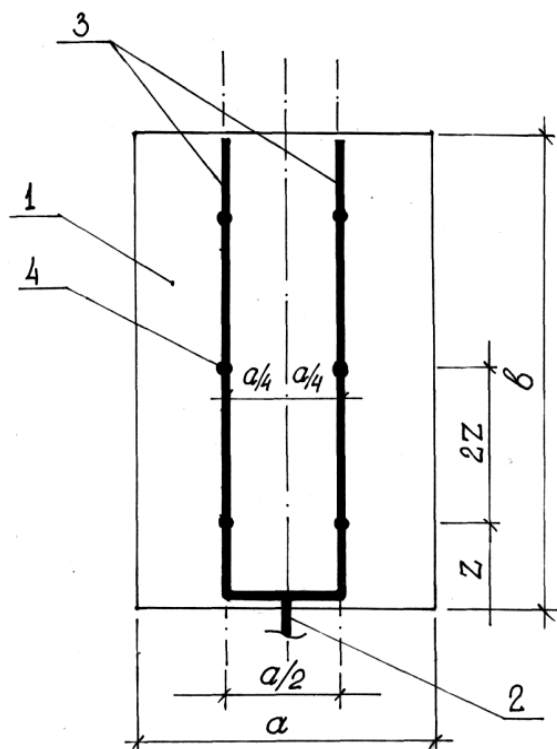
Схема розташування трубопроводів з розпилювачами під штабелем боєприпасів
